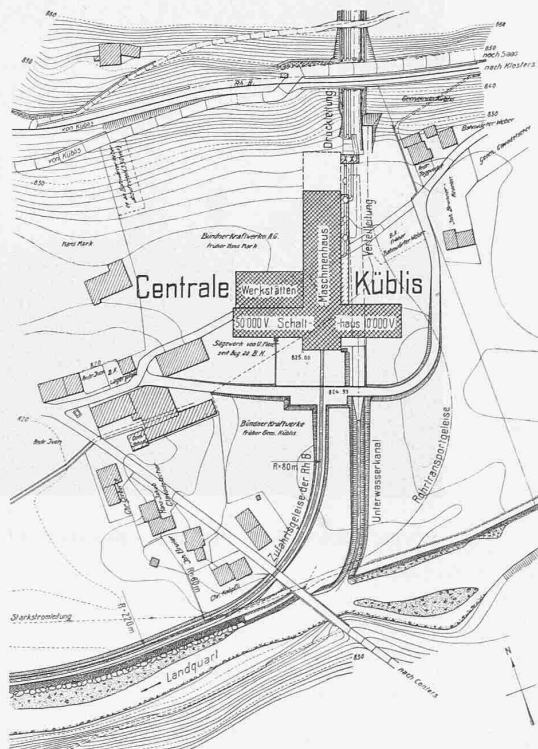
Lageplan der Zentrale Küblis. — Masstab 1 : 3000.
